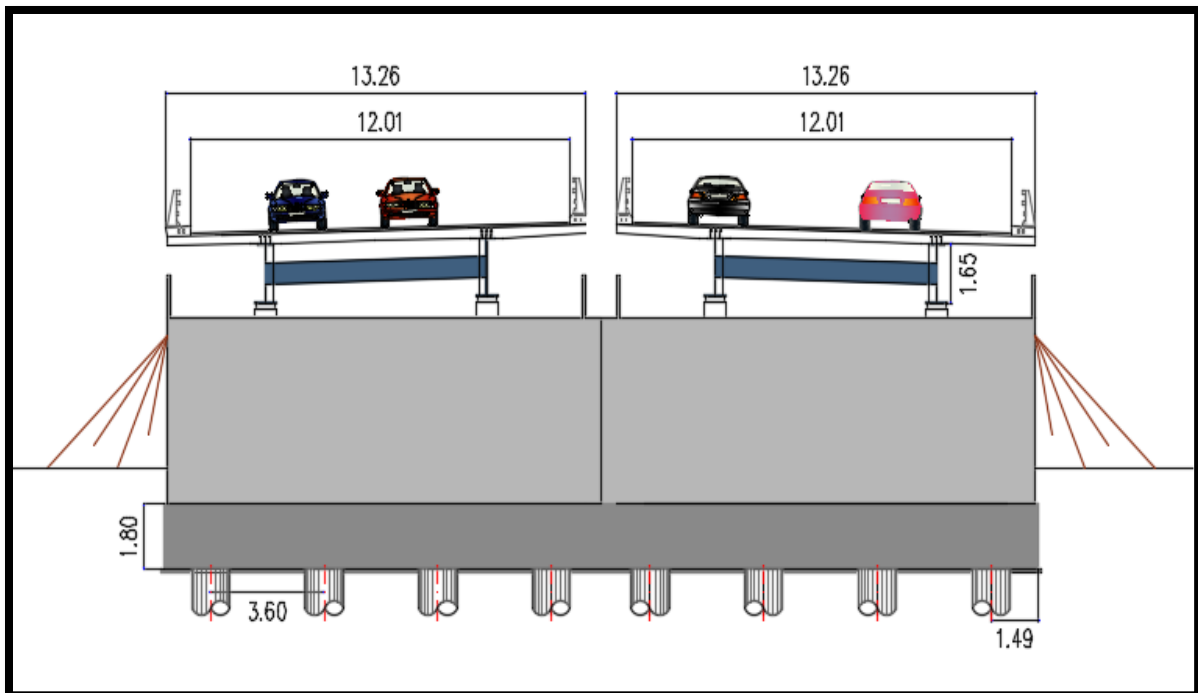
Coupe transversale sur culée VARIANTE 03
